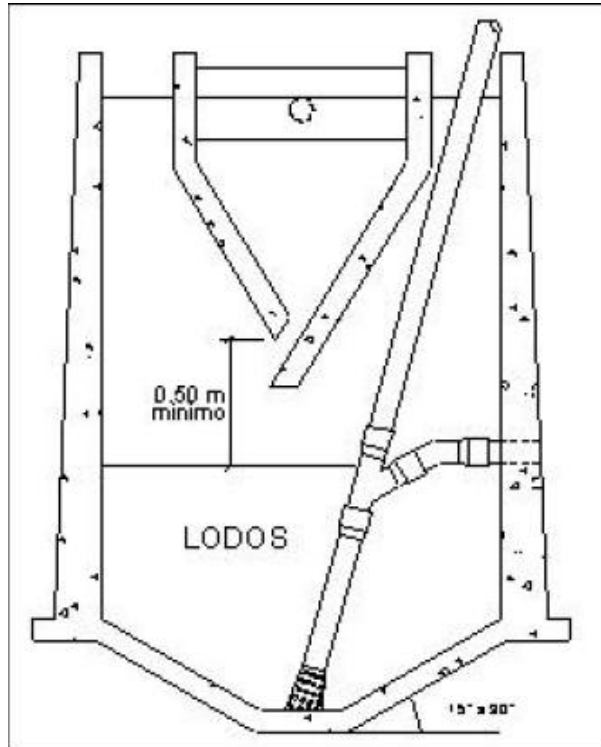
Detalle Constructivo del Tanque IMHOFF
